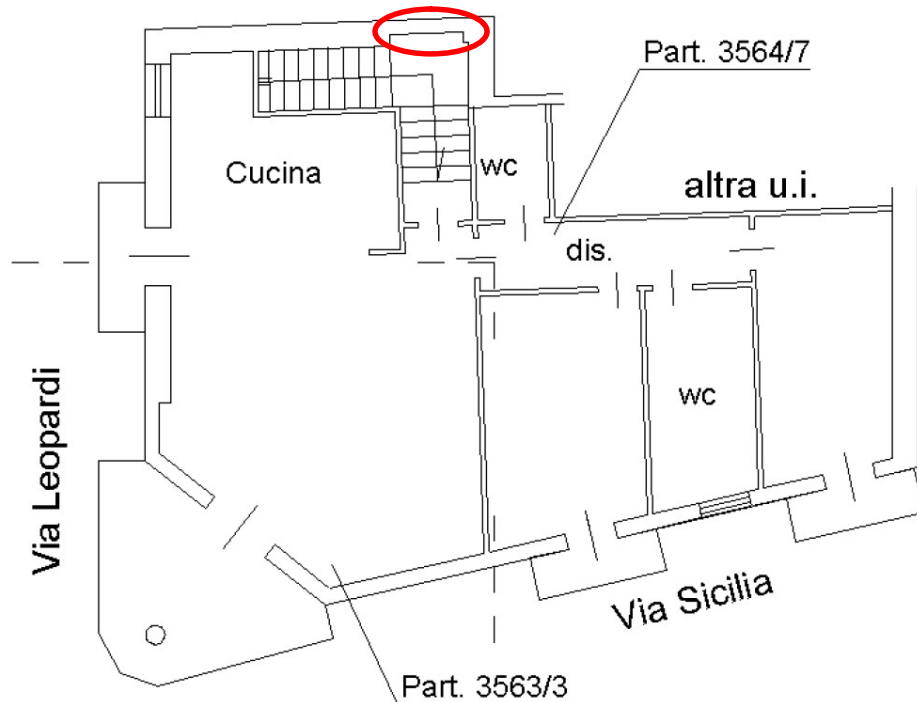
Planimetria catastale dell'appartamento in primo piano della signora con indicazione della nicchia ricavata nel muro di confine.
